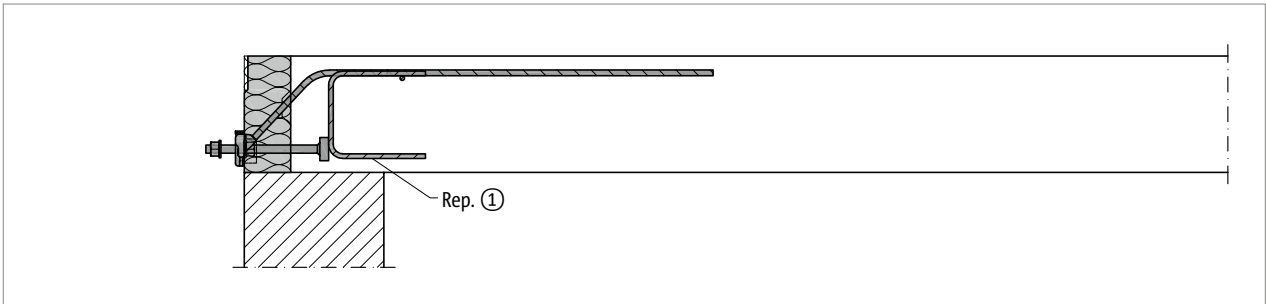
Schöck Isokorb® T type SQ : armatures à prévoir par le client, vue en coupe
